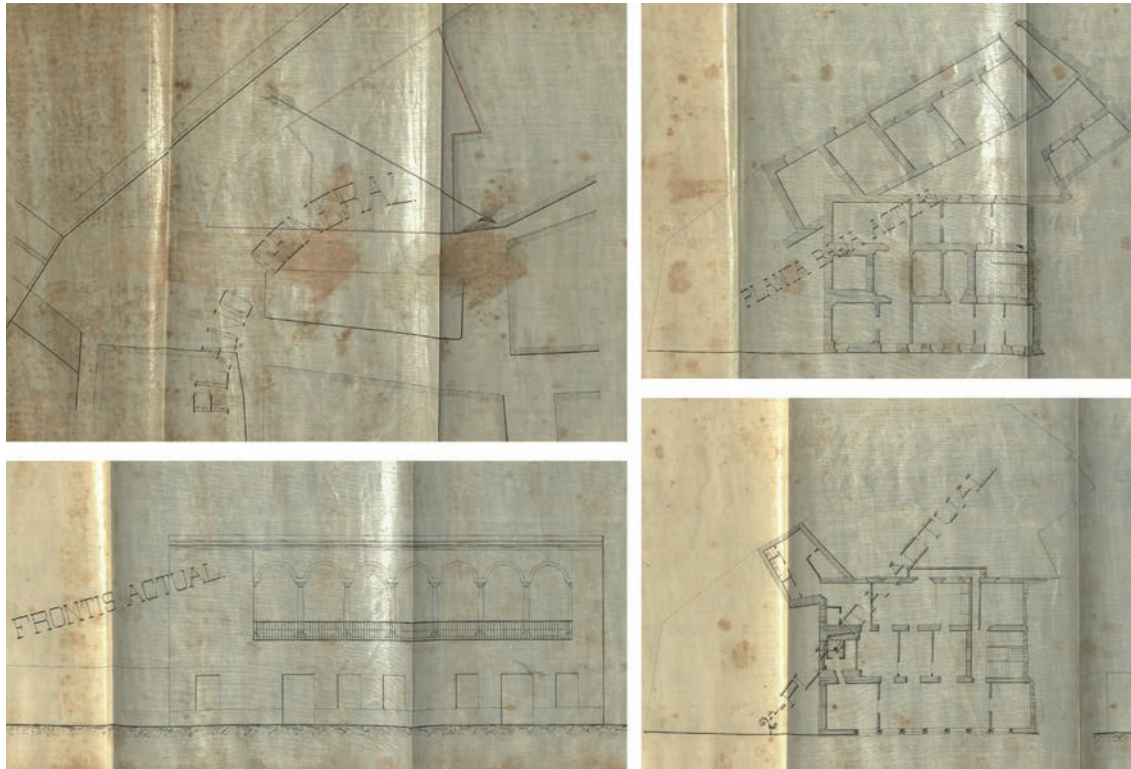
Fragmentos del plano de Carlos Mancha de 1884. Emplazamiento, alzado, planta baja y planta primera (AMC, Expediente CH02149_00021, Carlos Mancha, Plano del 14 de agosto de 1884).
